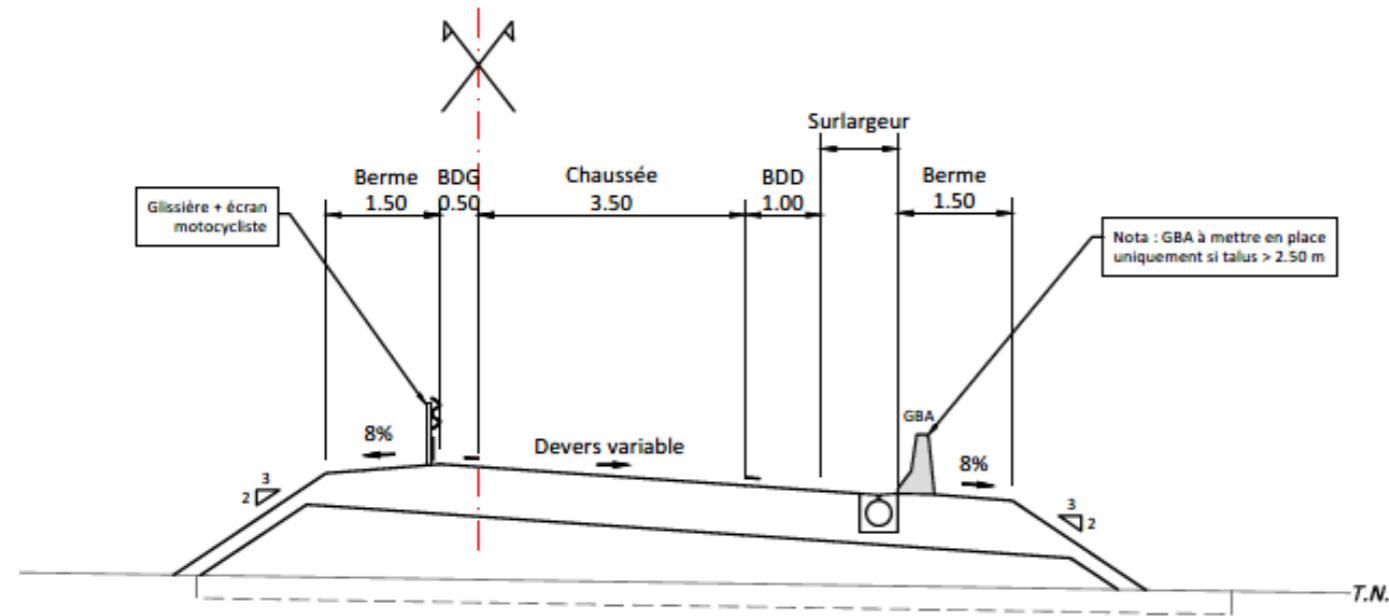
PROFIL EN TRAVERS TYPE – BRETELLE UNIDIRECTIONNELLE
